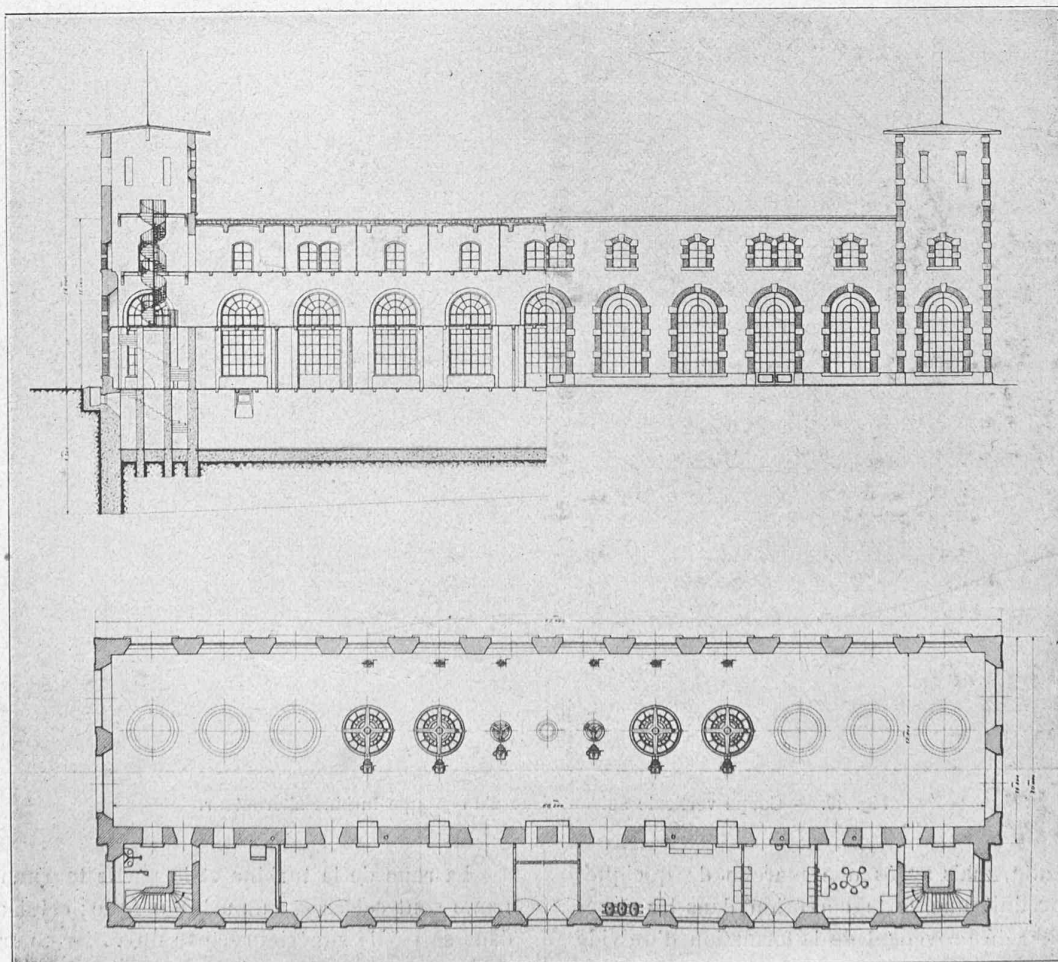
Plan et coupe de l'usine. — Echelle : 1 : 500.
